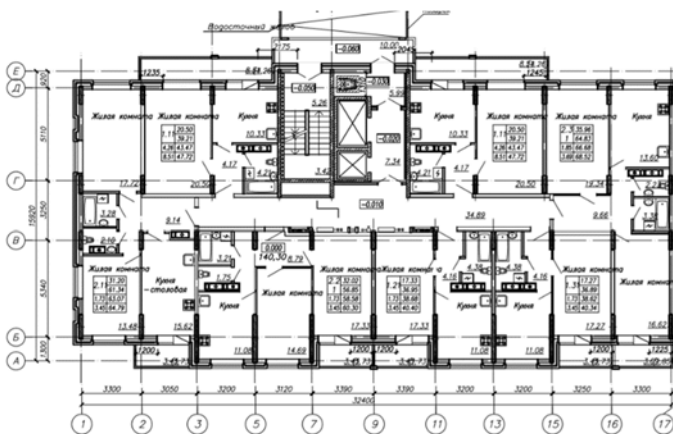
Фрагмент плана этажа поз. 13 мкр. №3 жилого района «Садовый» г. Чебоксары
